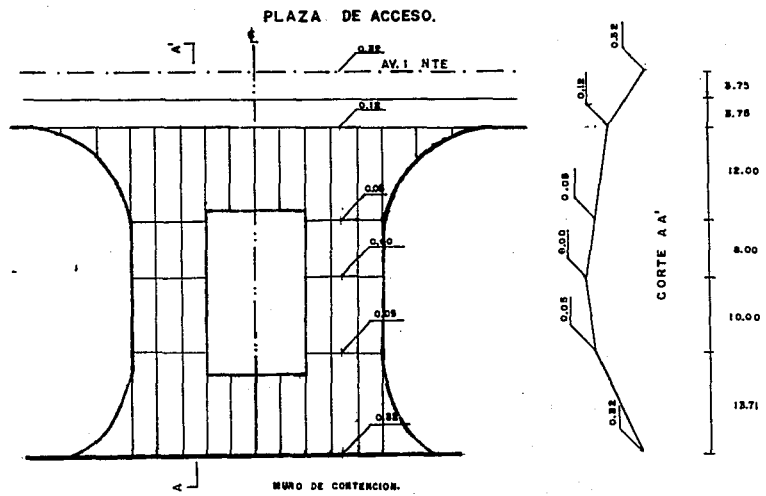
PLANTA Y CORTE DE PLAZA DE ACCESO.
